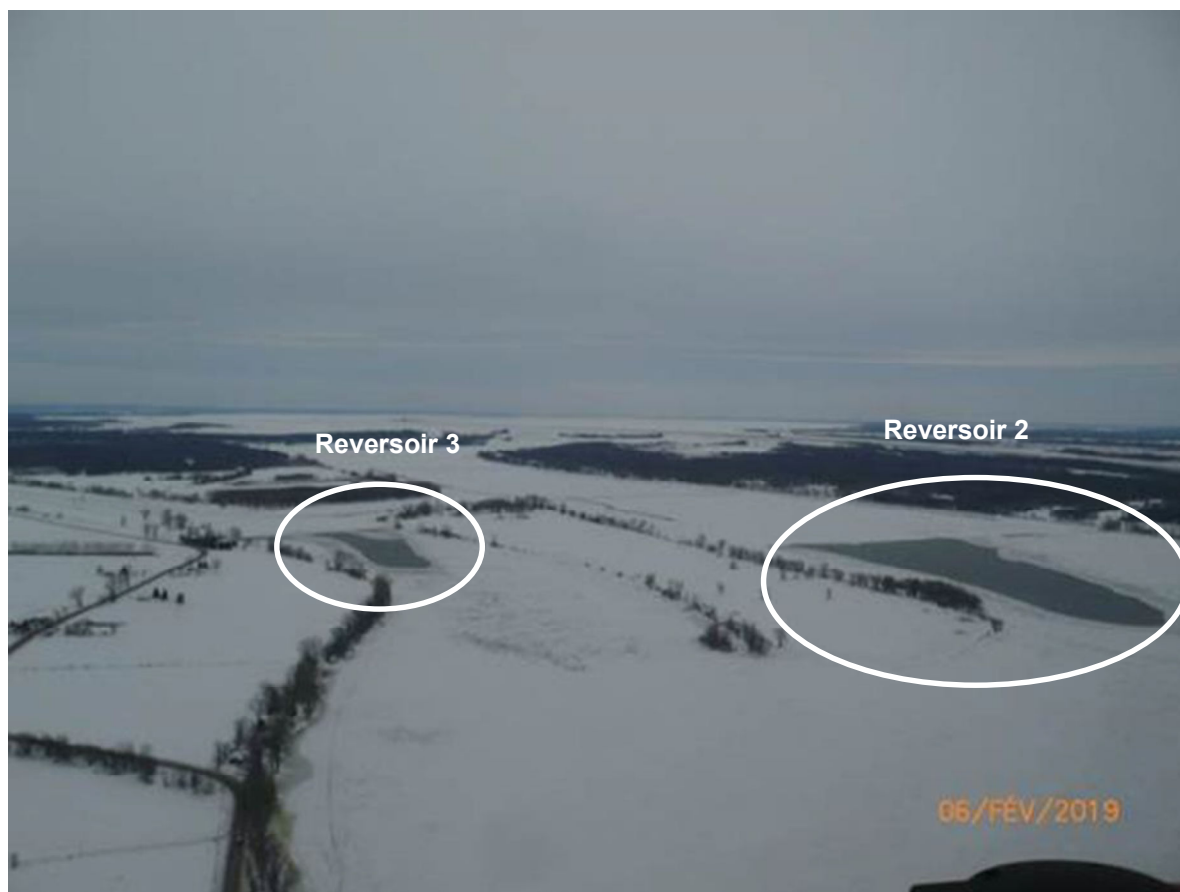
Reversoir 2 et 3 – Zone libre de glace en amont des ouvrages (6 février 2019)
